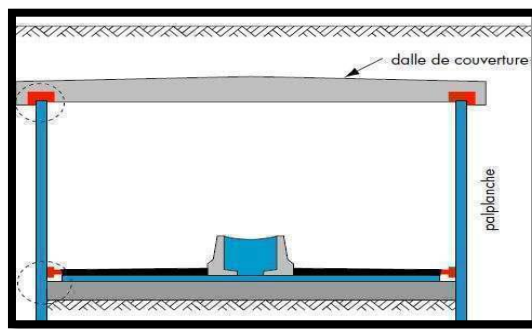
Etanchement horizontal dans le cas d'un tunnel ou une structure enterrée (13)
